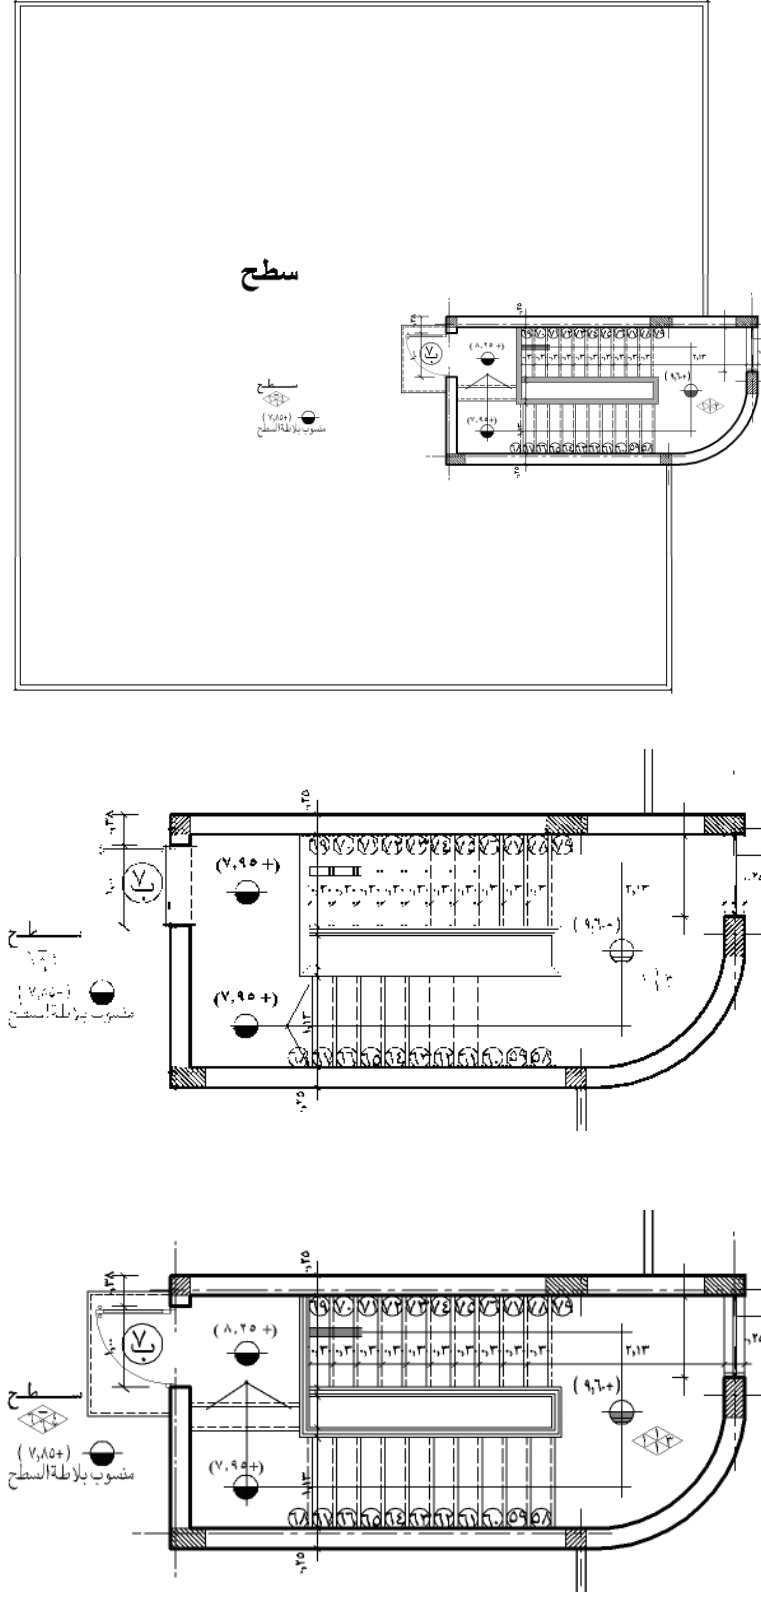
مثال على مسقط أفقي تنفيذي لدور سطح
